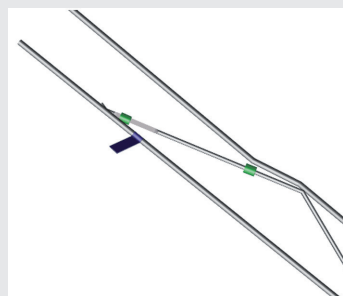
Armadura GEOFOR® con la geometría modificada en el extremo
